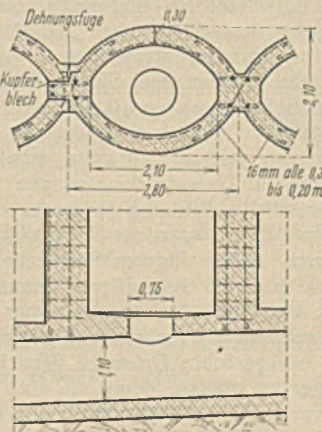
Eisenbetonzellenkern mit gewölbten Wänden des Requenadamms in Mexiko.
